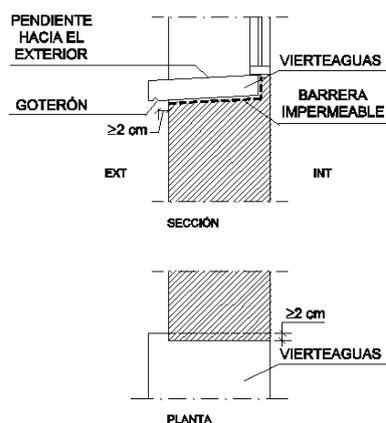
Ejemplo de encuentro de la fachada con la carpintería
